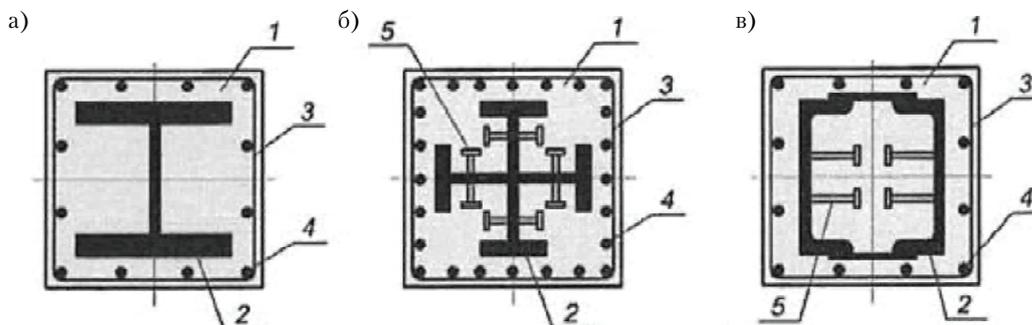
Типовые поперечные сечения сталежелезобетонных конструкций: а) жесткая арматура в форме двутавра; б) жесткая арматура в форме крестообразного сечения; в) жесткая арматура коробчатого сечения; 1 – бетон; 2 – жесткая внутренняя арматура; 3 – жесткая наружная арматура; 4 – продольная гибкая арматура; 5 – упор.
